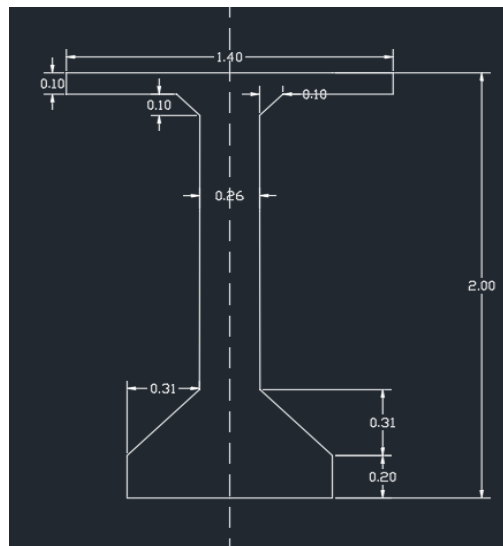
Coupe transversale en travée d'une poutre du tablier
